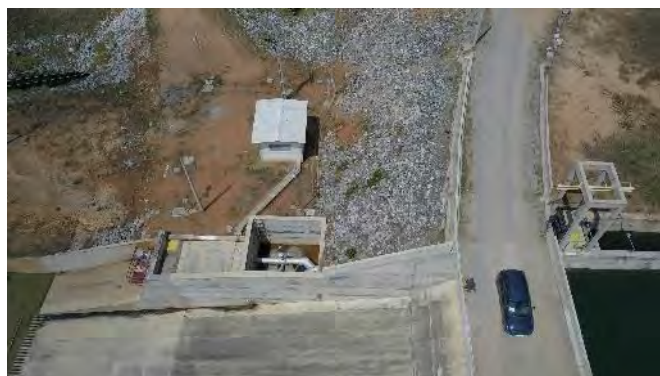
Barragem Barro Branco - Casa de Comando da TUD
